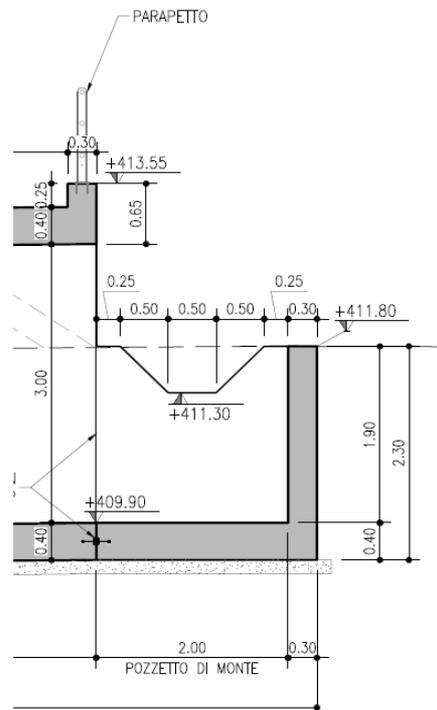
Manufatto d'imbocco - Sezione longitudinale
